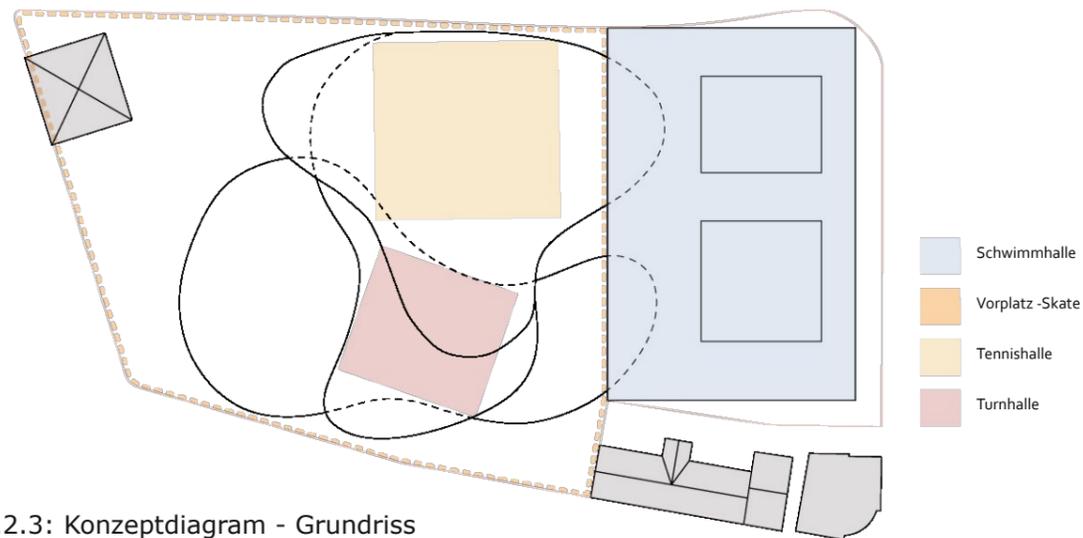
Konzeptdiagramm - Grundriss
